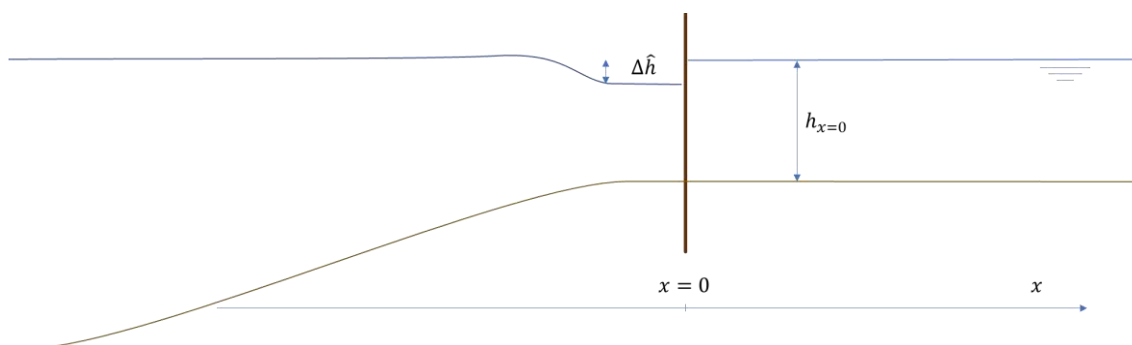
Schematisering van de bodem en constructie t.b.v. latere berekeningen
